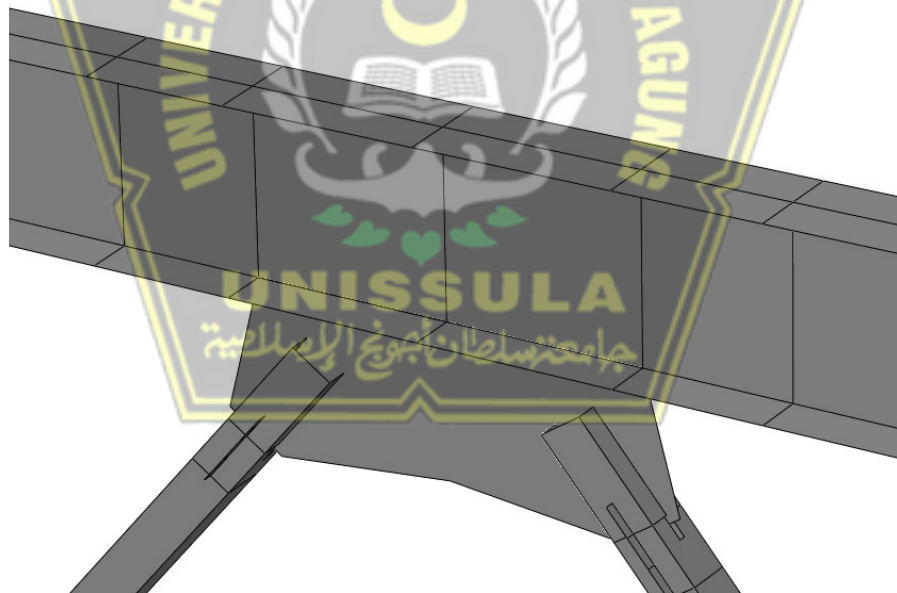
Detail Sambungan Bresing-Balok-Kolom spesimen 1 dan 2
